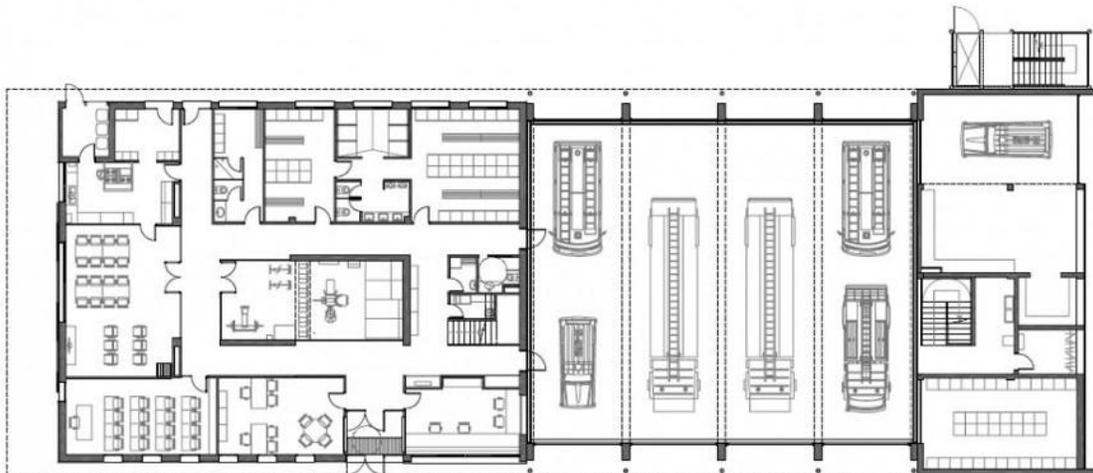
Planta Arquitectónica, de estación de Bomberos, Francesc Rubí, 2011
